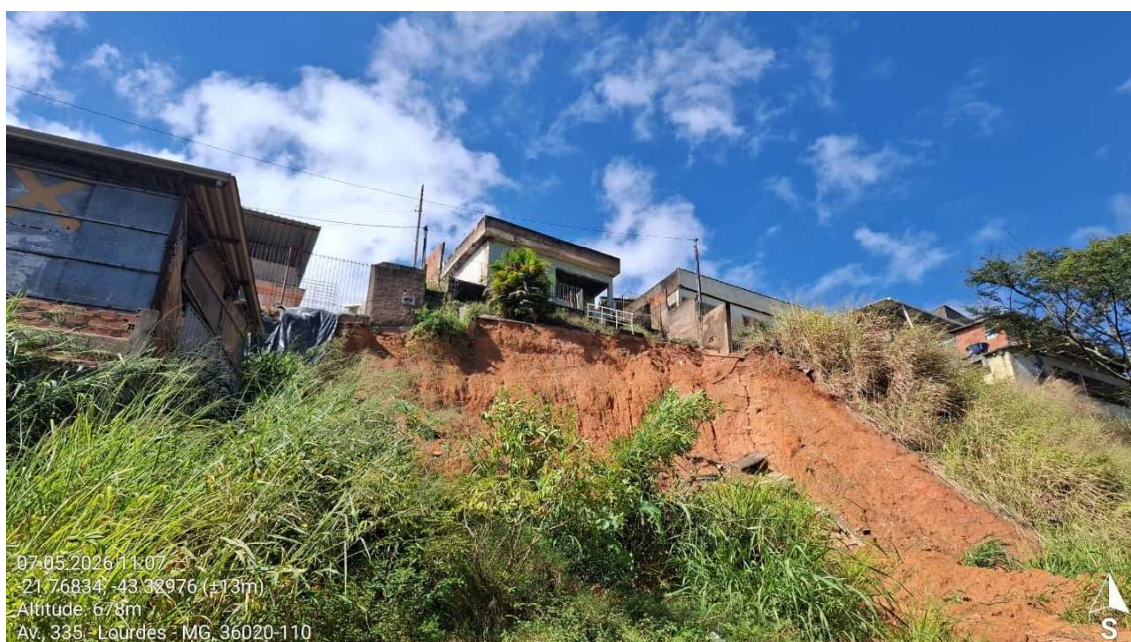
Local de intervenção: -21.768457, -43.329645 - Vista de outra perspectiva, em nível inferior à travessa, do trecho afetado pelo deslizamento de solo do talude adjacente à via, com colapso total do trecho da travessa configurada em uma escadaria (escadão) pública.
